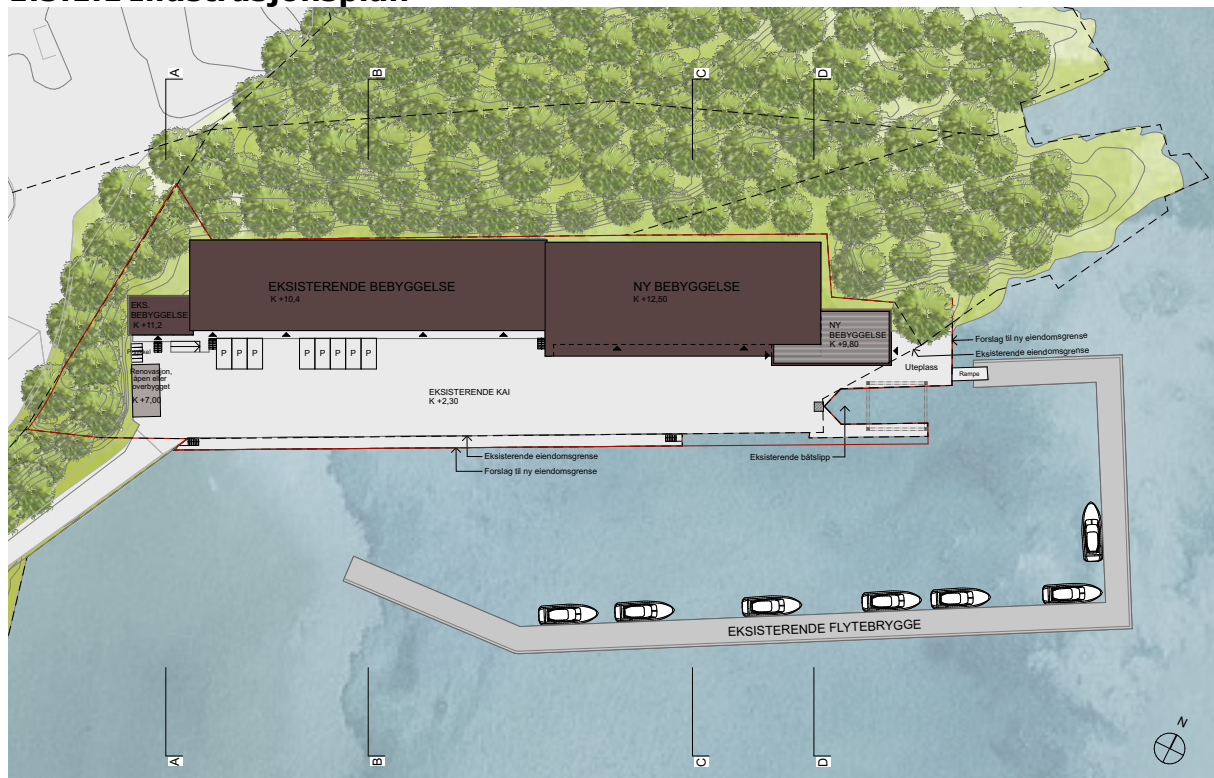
Illustrasjonsplan, følger også planforslaget som vedlegg A10.
